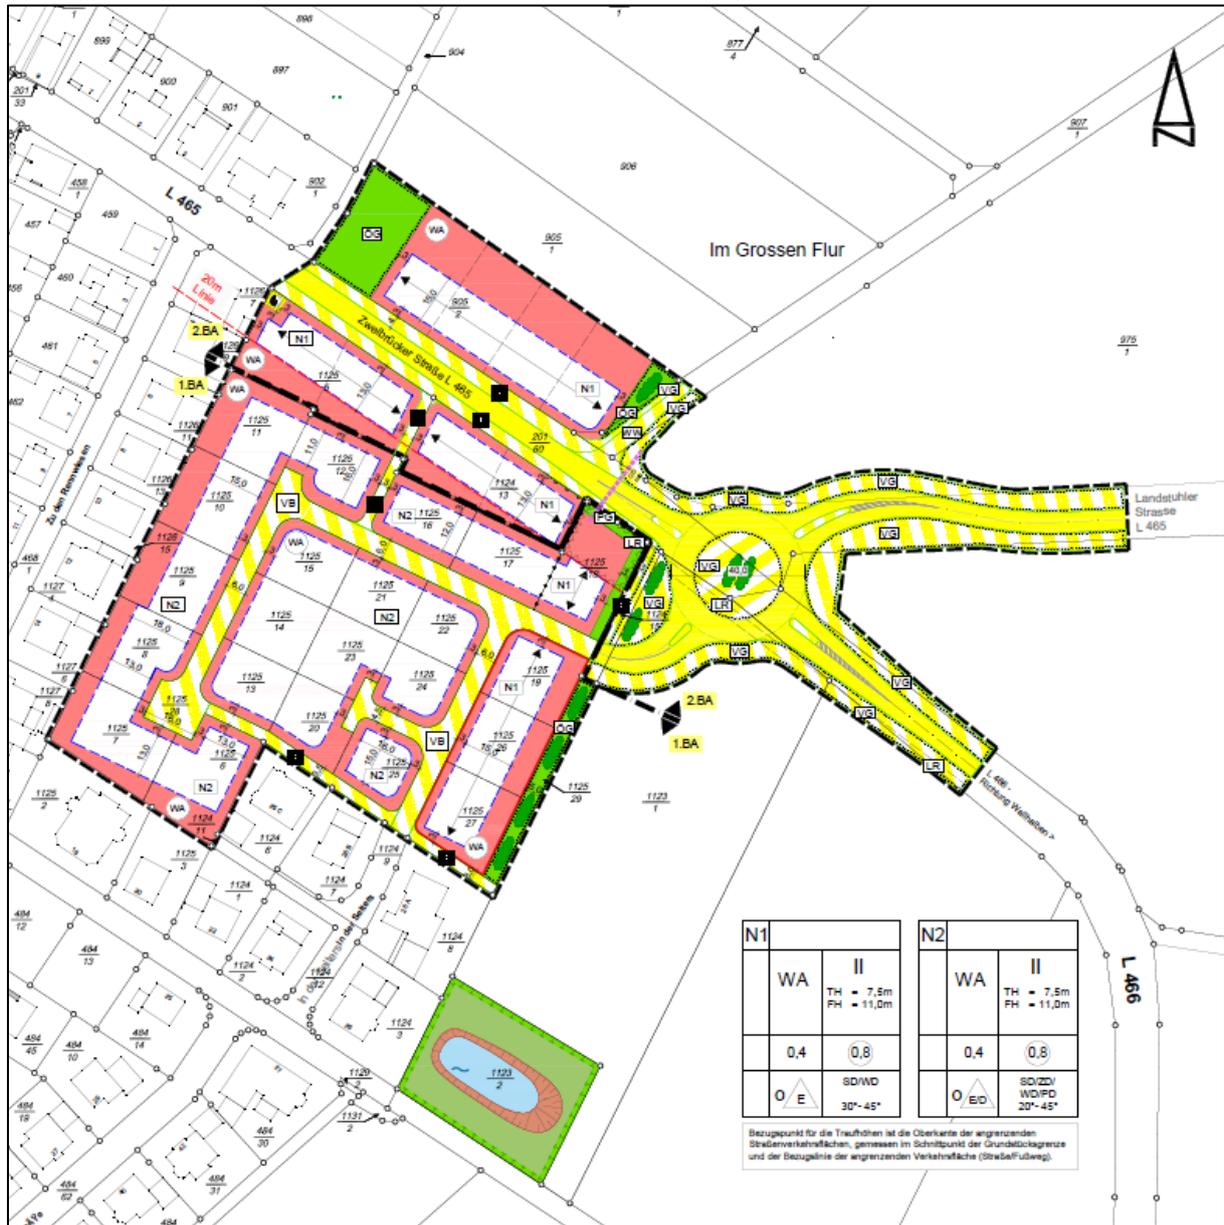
Zu den Rennwiesen, 1. Änderung – Planzeichnung (ohne Maßstab)
